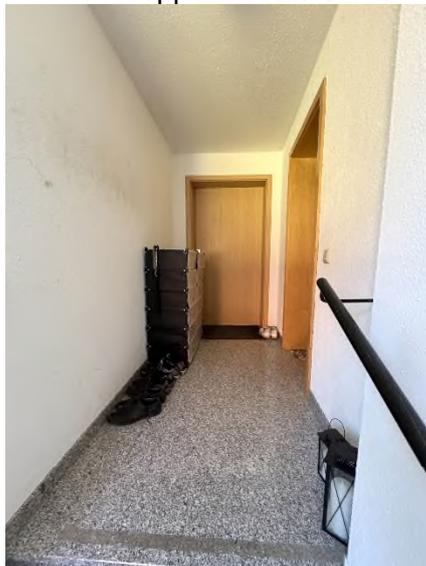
und Bild 9 – Flur zu den Abstellräumen und zum Heizungsraum
